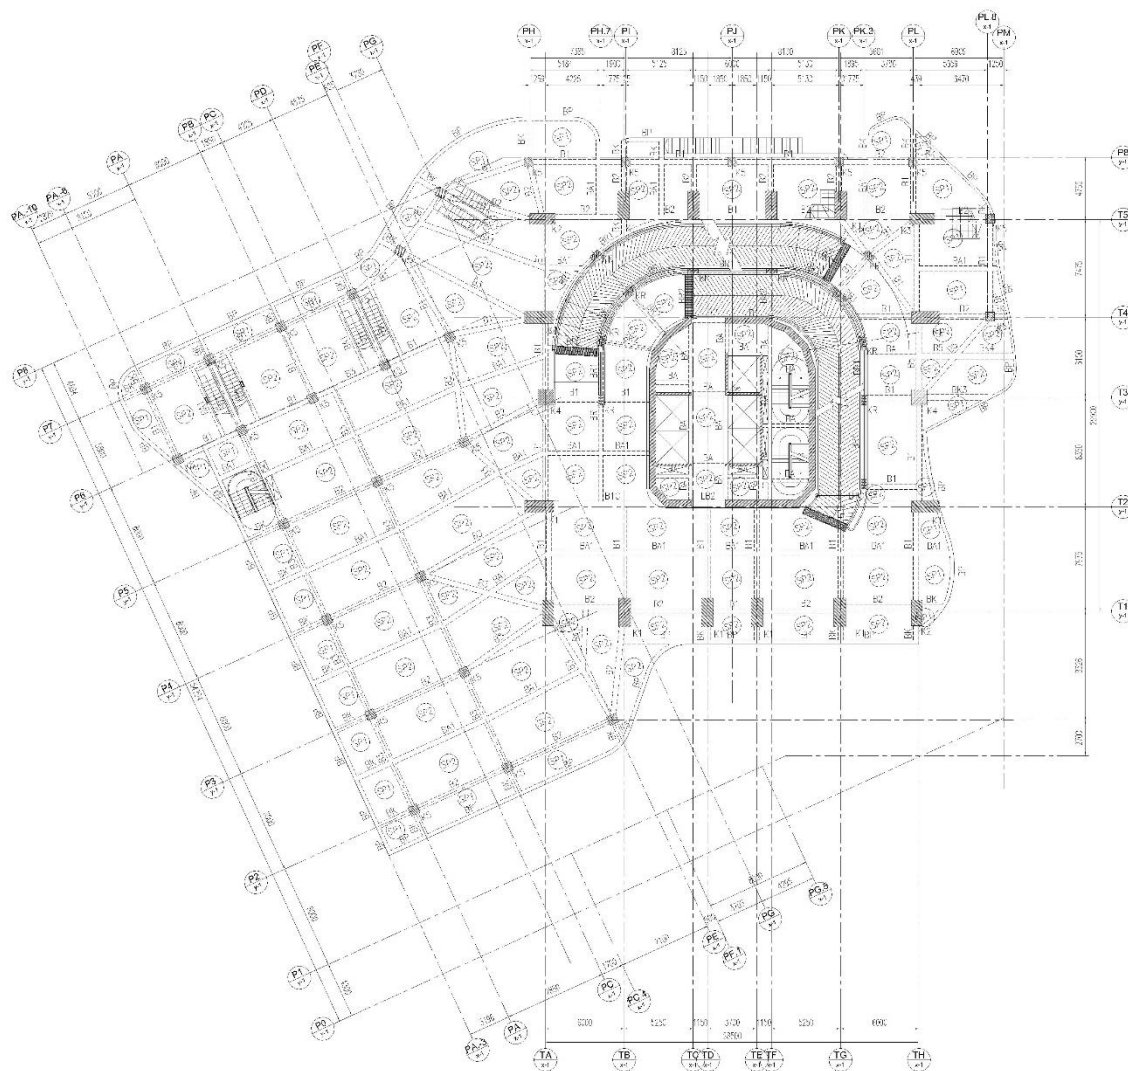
Denah Lantai 3 (Pooldeck)
